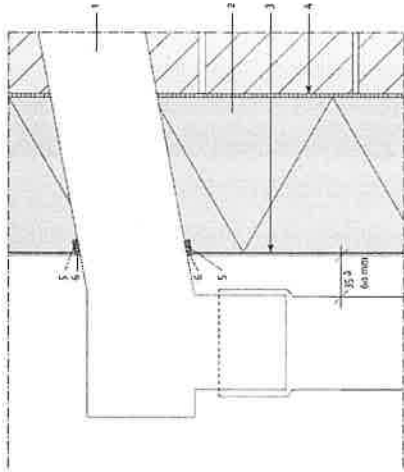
Traversée par une évacuation d'eaux pluviales.
